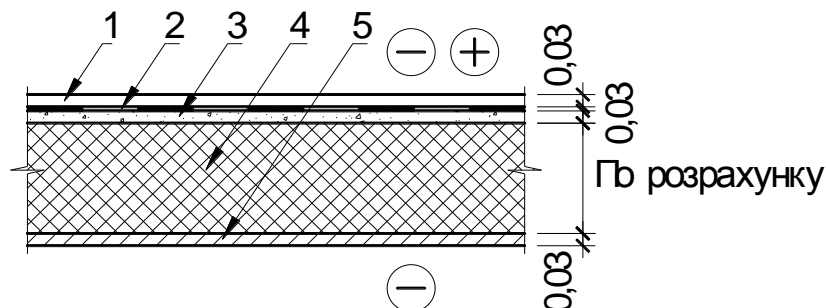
Конструкція покриття будівель холодильників: 1 – руберойд ний килим; 2 – пароізоляція; 3 – привантажувальний шар; 4 – утеплювач; 5 – плита покриття
